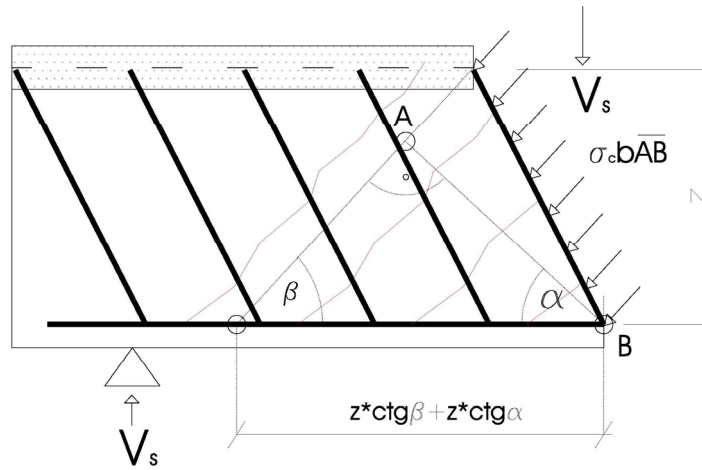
Equilibrio de esfuerzos aportado por el hormigón
